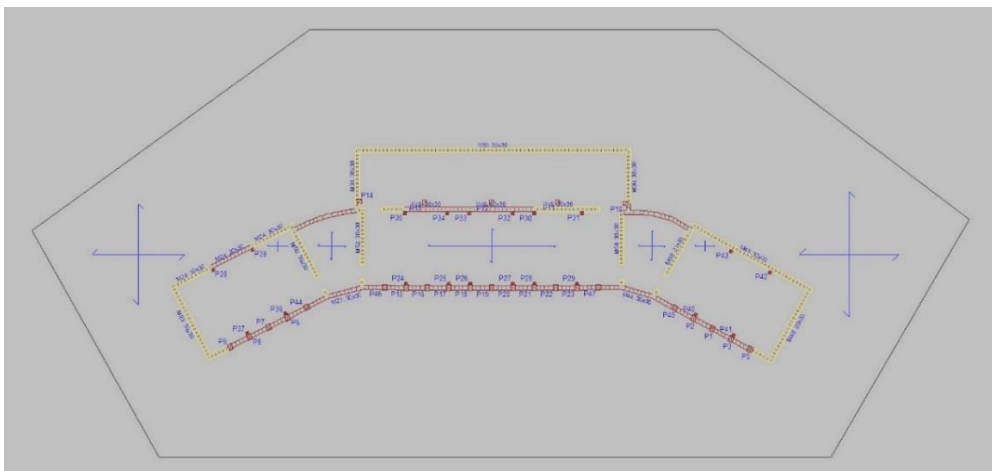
Planta baja del modelo de 5 plantas simplificado
